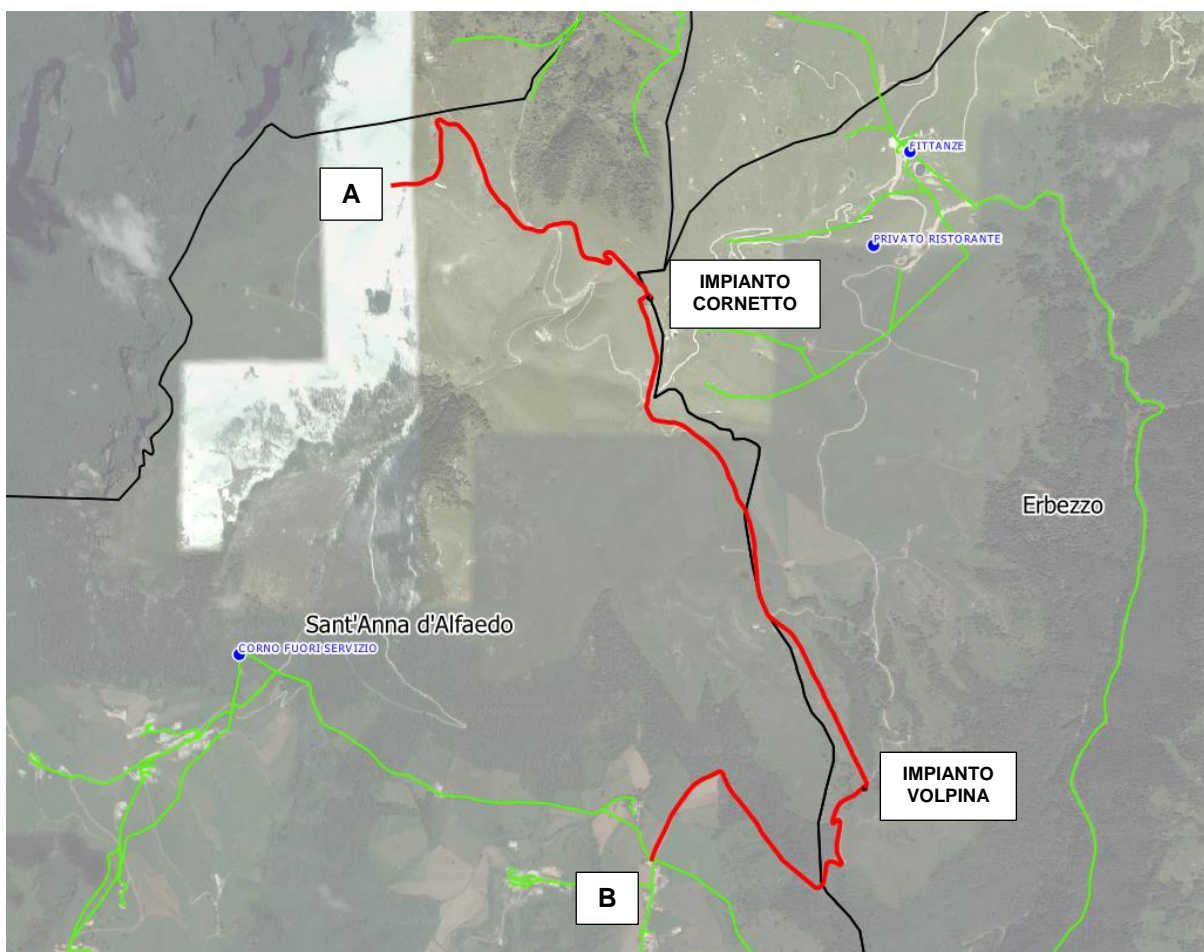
Planimetria generale del tracciato AB. In rosso il tracciato di progetto, in verde la rete esistente.
